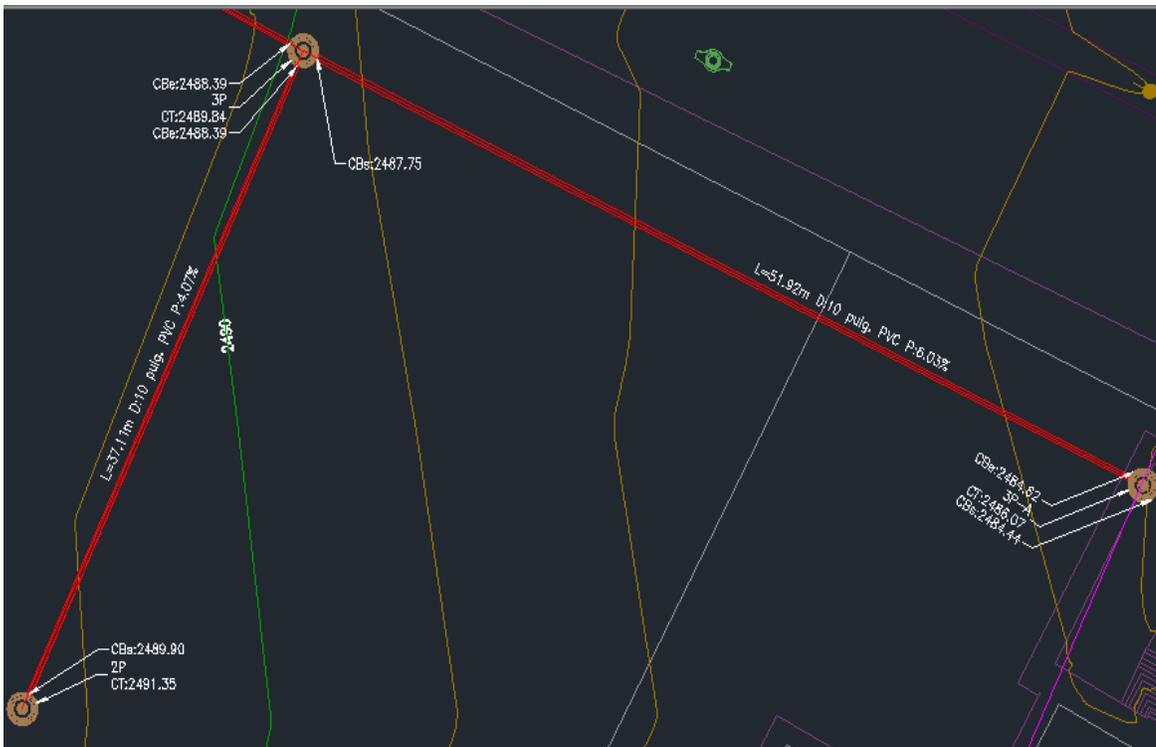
Diseño alcantarillado pluvial tramo 2P a 3P; 3P a 3PA.
